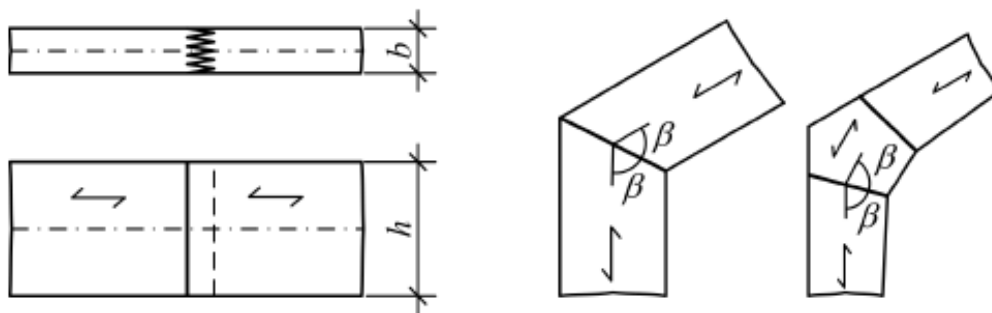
Aboutages à entures multiples de grandes dimensions d'une poutre et d'un assemblage de crose.
